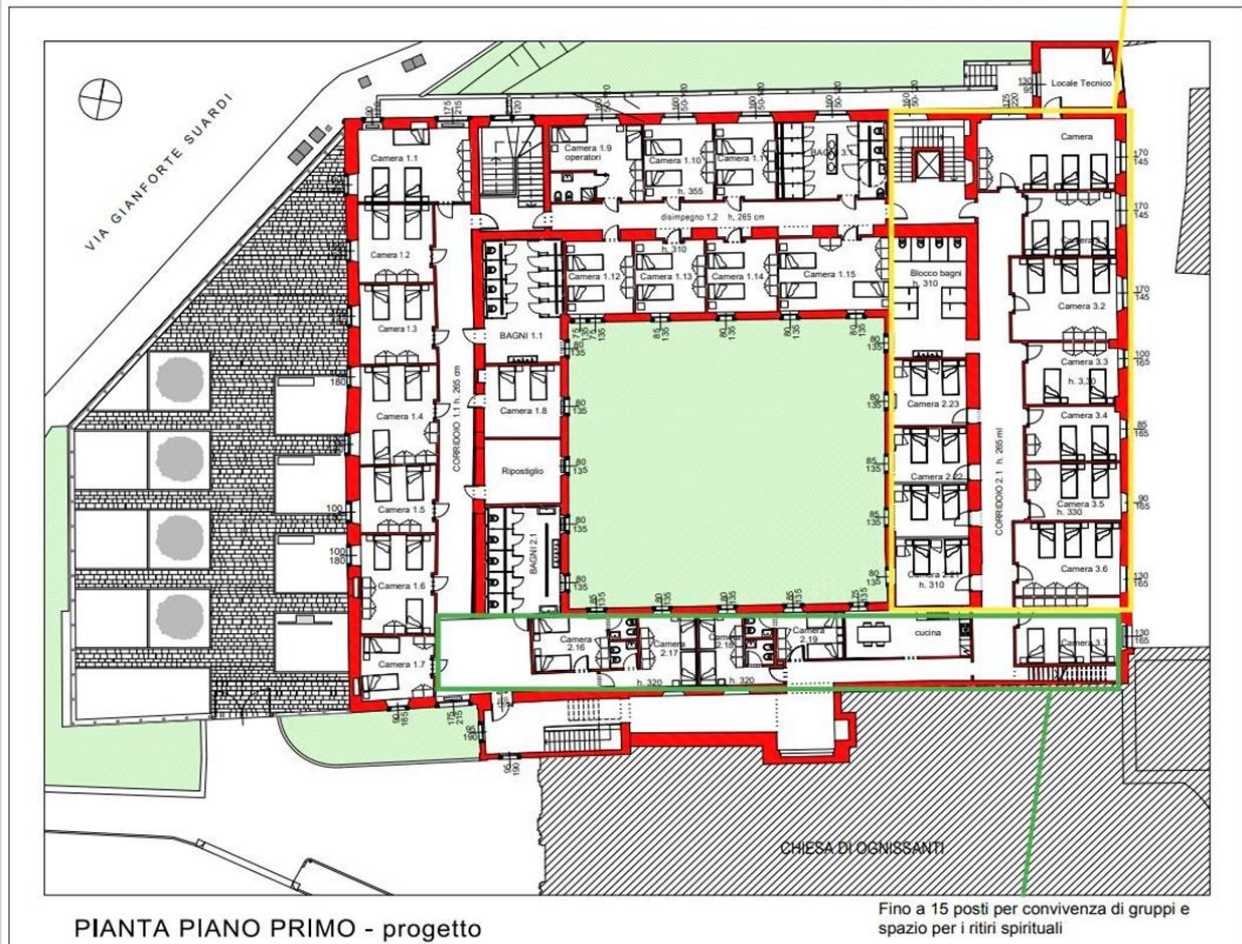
Pianta del primo piano con, contornati in giallo e in verde, le parti da ristrutturare
